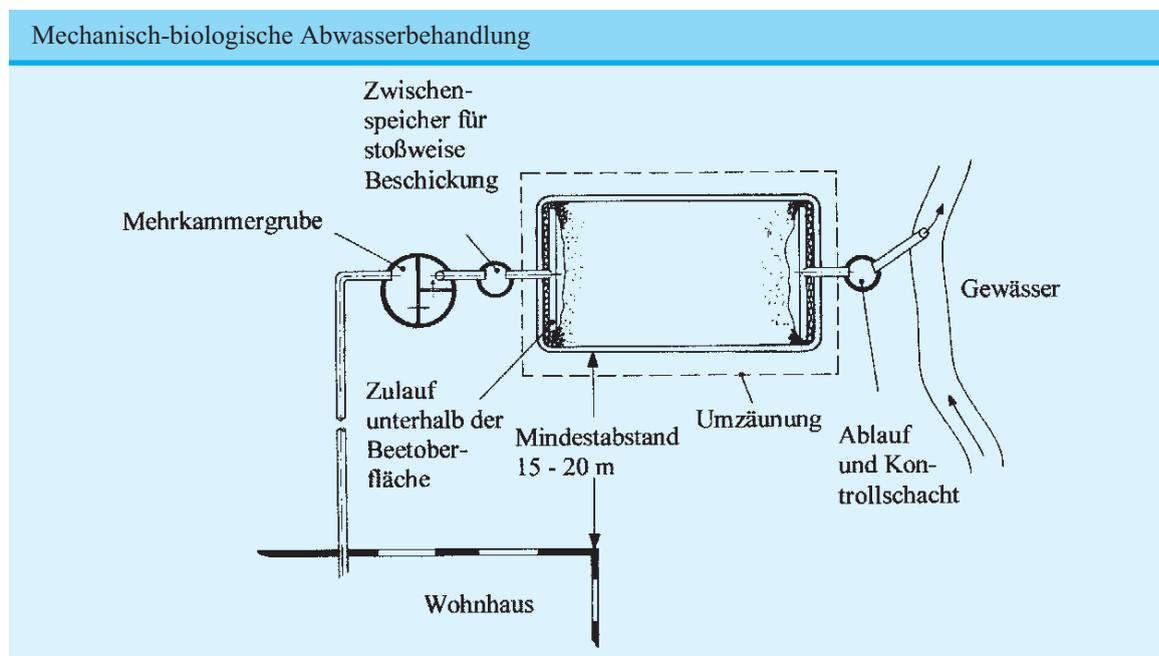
Übersichtsschema einer Kleinkläranlage mit Pflanzenbeet
